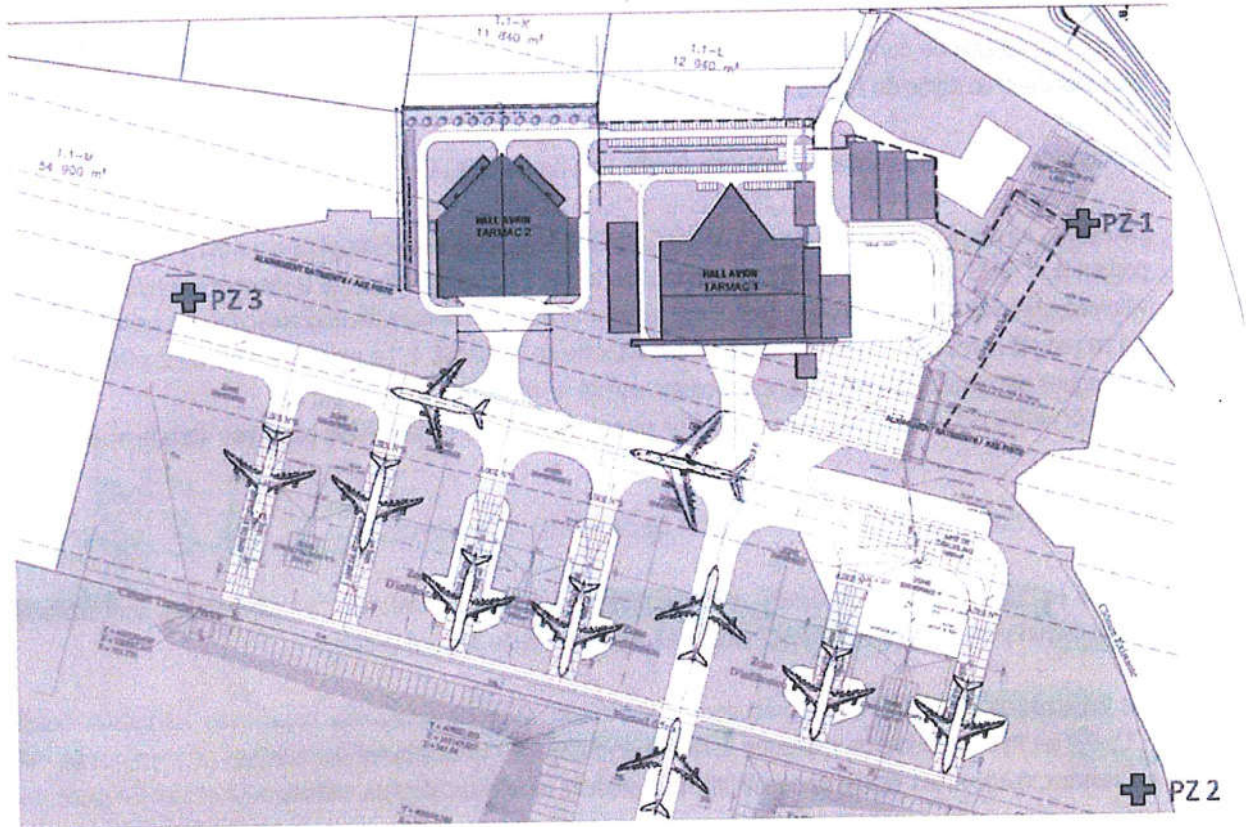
IMPLANTATION DES PIÉZOMÈTRES SUR LE SITE
